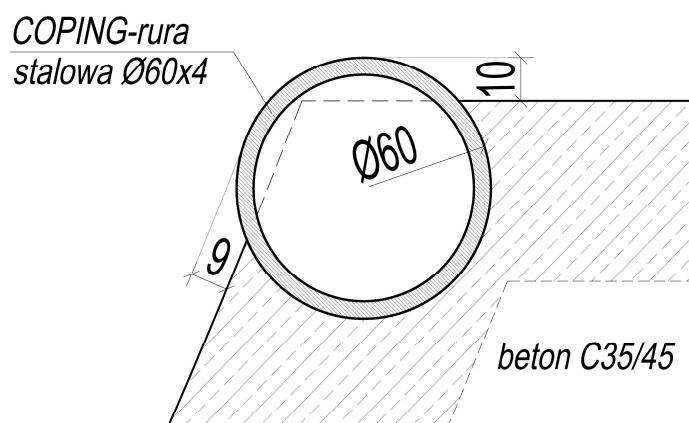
Profil równo „wtopiony” w krawędź elementu. Do profilu przyspawane marki z drutu stalowego w celu pewnego zakotwienia w betonie
